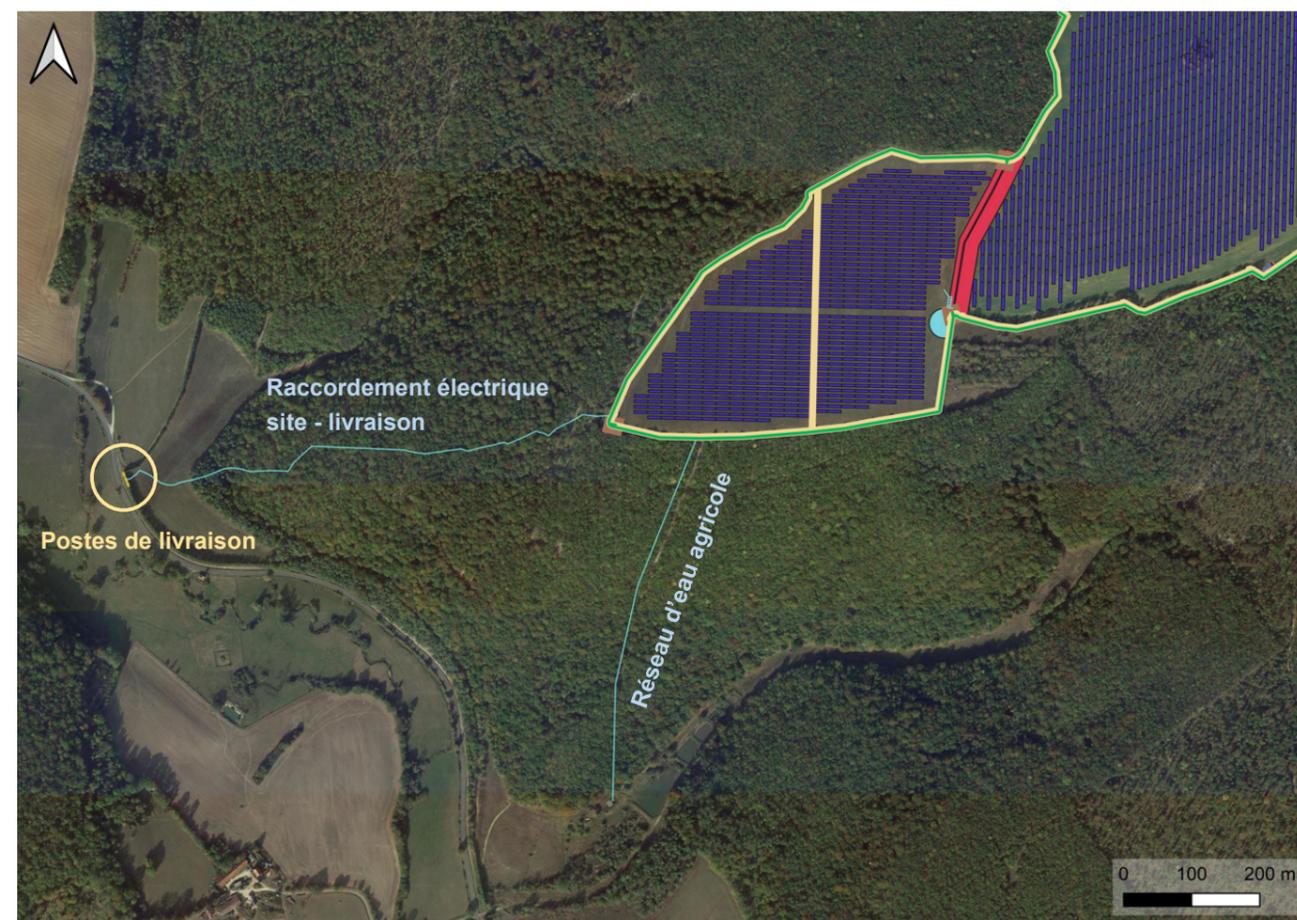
Raccordement site - postes de livraison (source : Plenitude)
